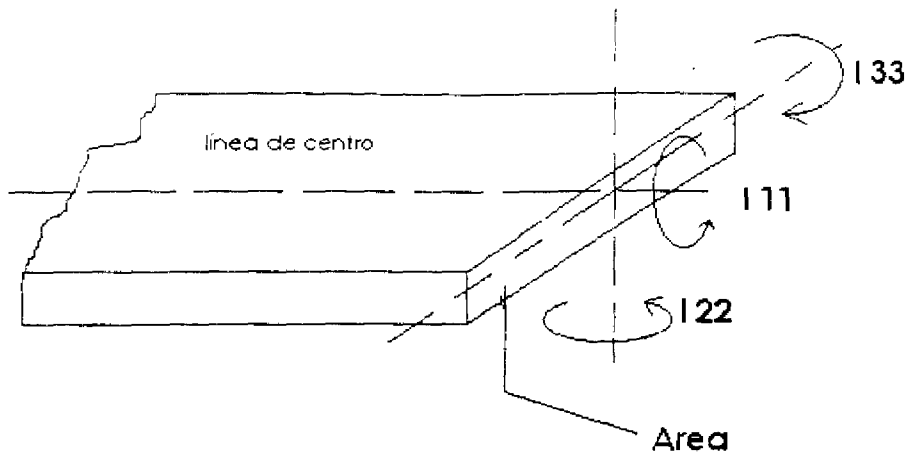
Convención para las propiedades de sección de la superestructura.
